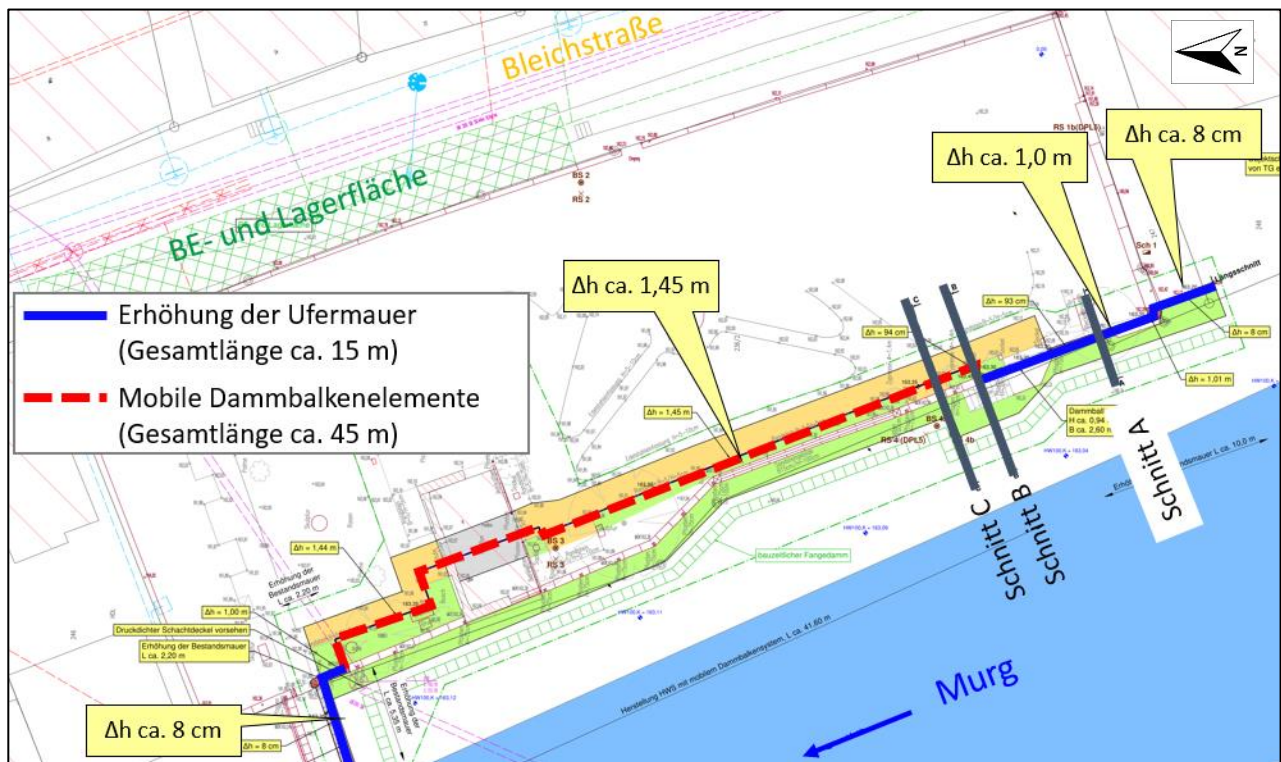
Lageplan GE5 mit geplanter Hochwasserschutzmaßnahme
